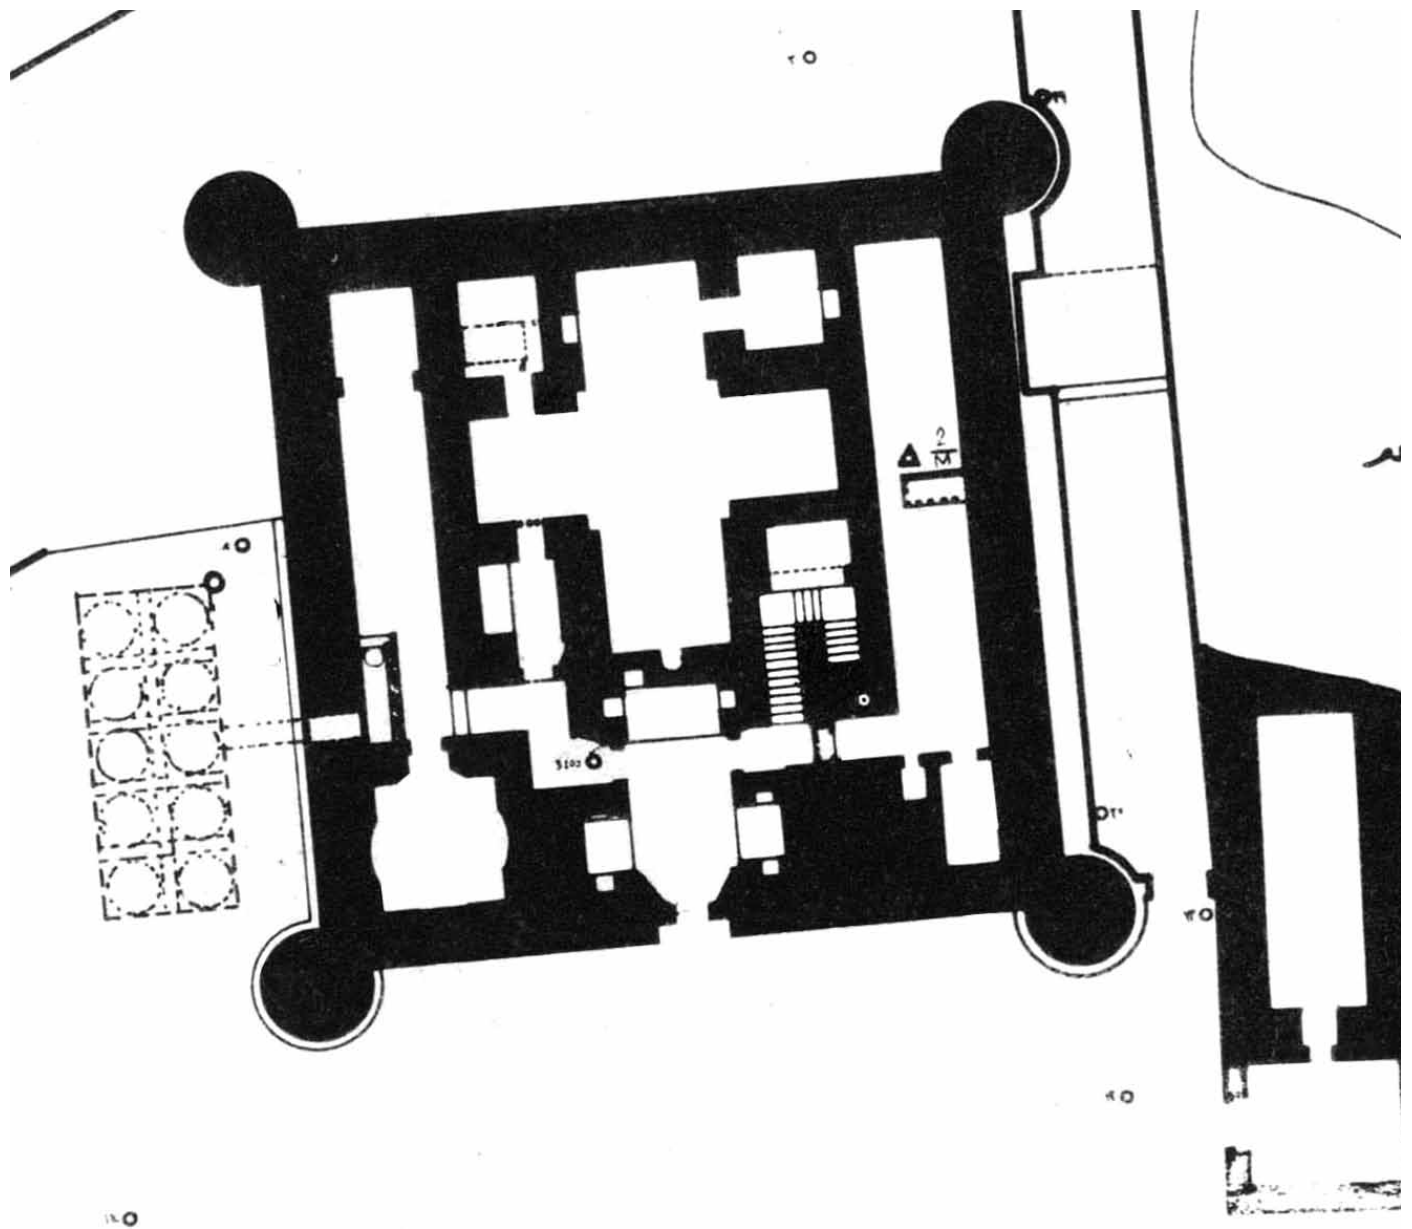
Hauptturm: Grundriss Erdgeschoss (SAFWAT EL ALFY 1984).
